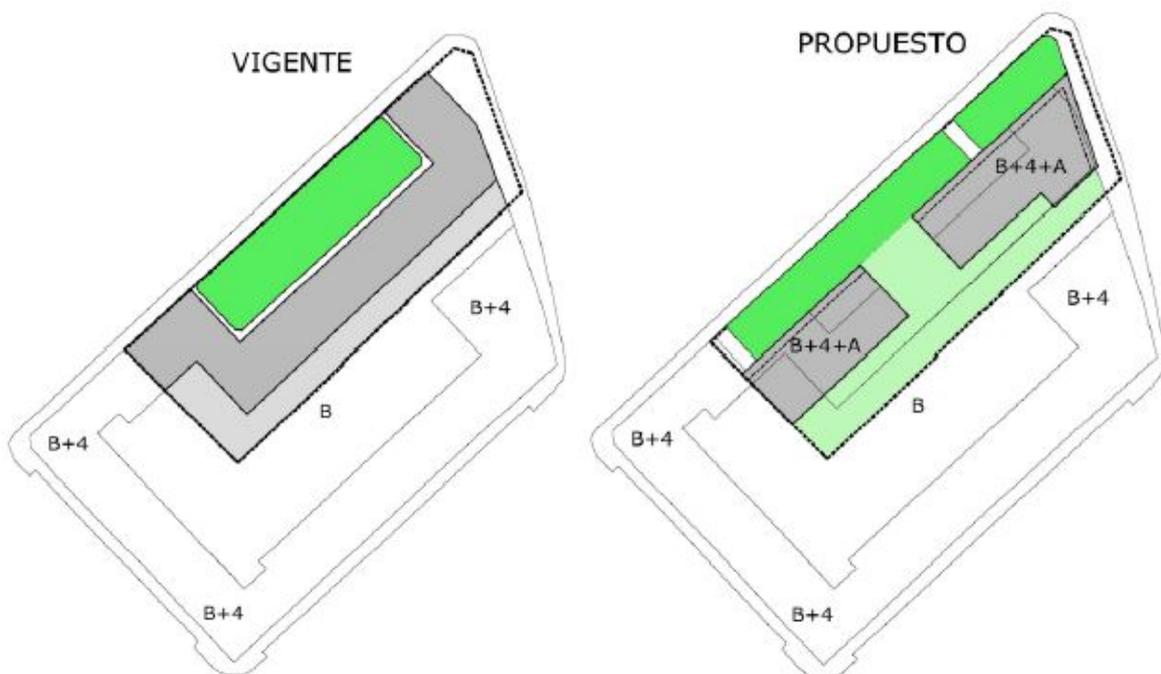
Ordenación vigente y propuesta para la U.E.-8 BERBES de Calahorra.
